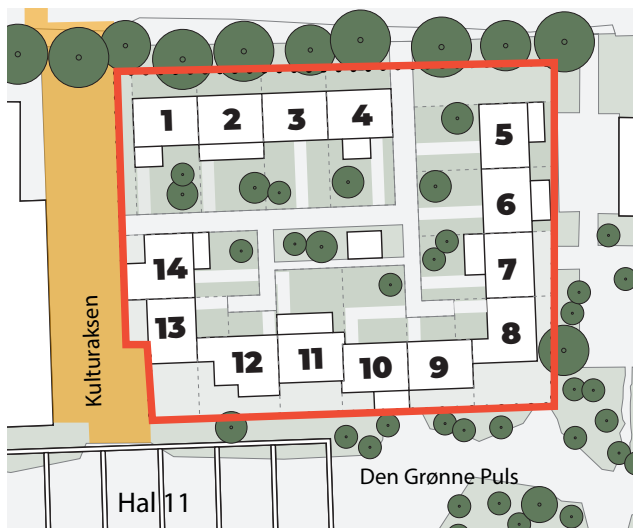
Udsnit af bilag 2 og 6. Overblik over grundpriser ex. moms. Til grundpriserne skal tillægges pristillæg for parkering, affald og byggemodning.
